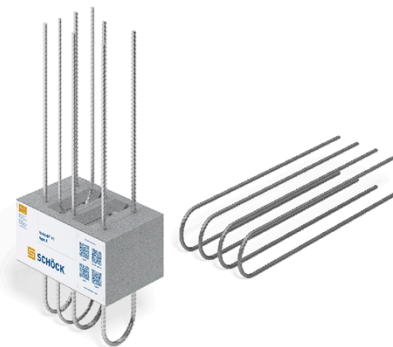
Schöck Isokorb® Typ A für Brüstungen und Attiken
